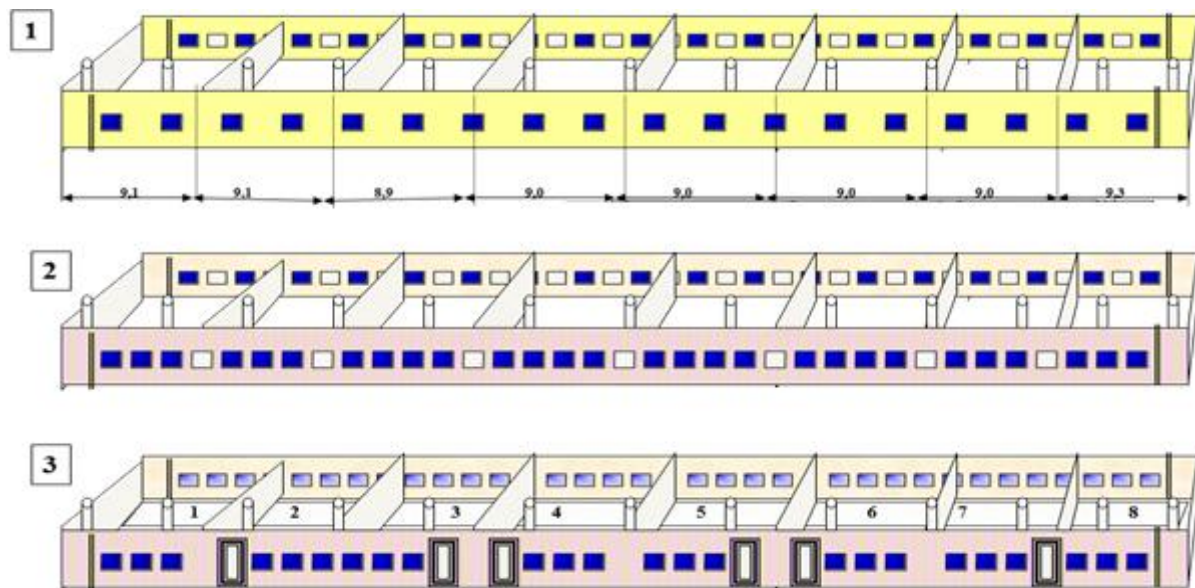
Схема реконструкции оконных и дверных проемов в здании фермы, реабилитируемой в жилой дом (1-й этаж):
